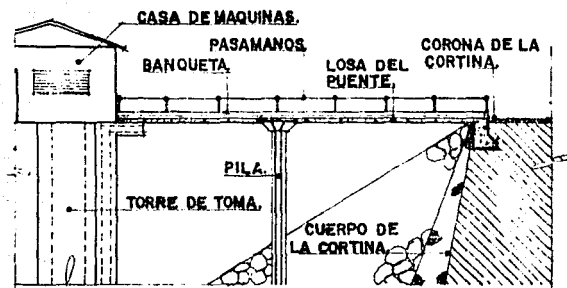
PUENTE DE ACCESO A LA OBRA
